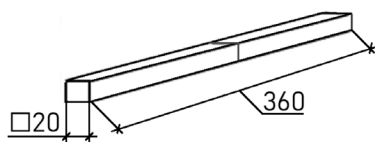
Форма и размеры образца для проведения кратковременных и длительных испытаний
